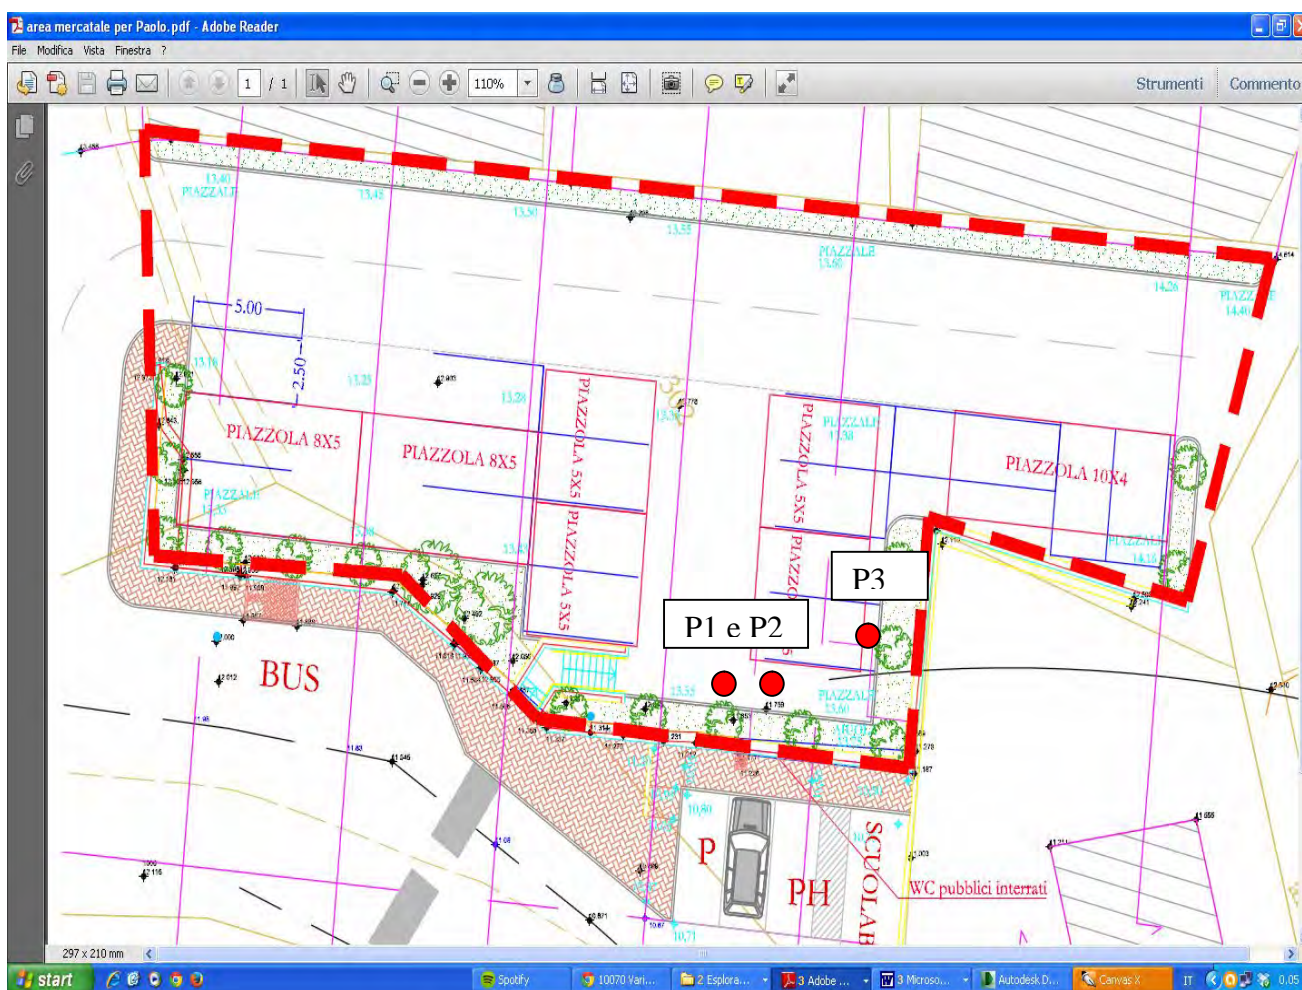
Planimetria con ubicazione delle prove penetrometriche.
